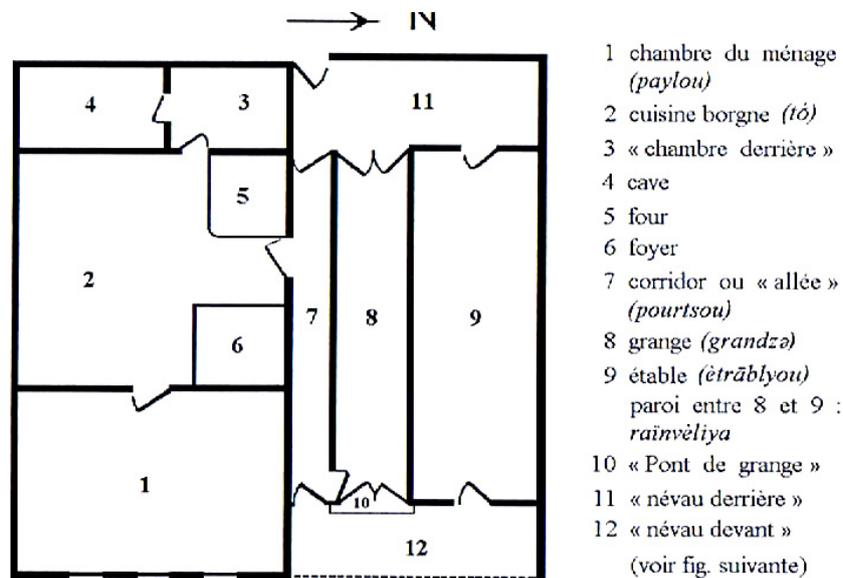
Plan d'une ferme ancienne (dimensions 20 x 20 m)
